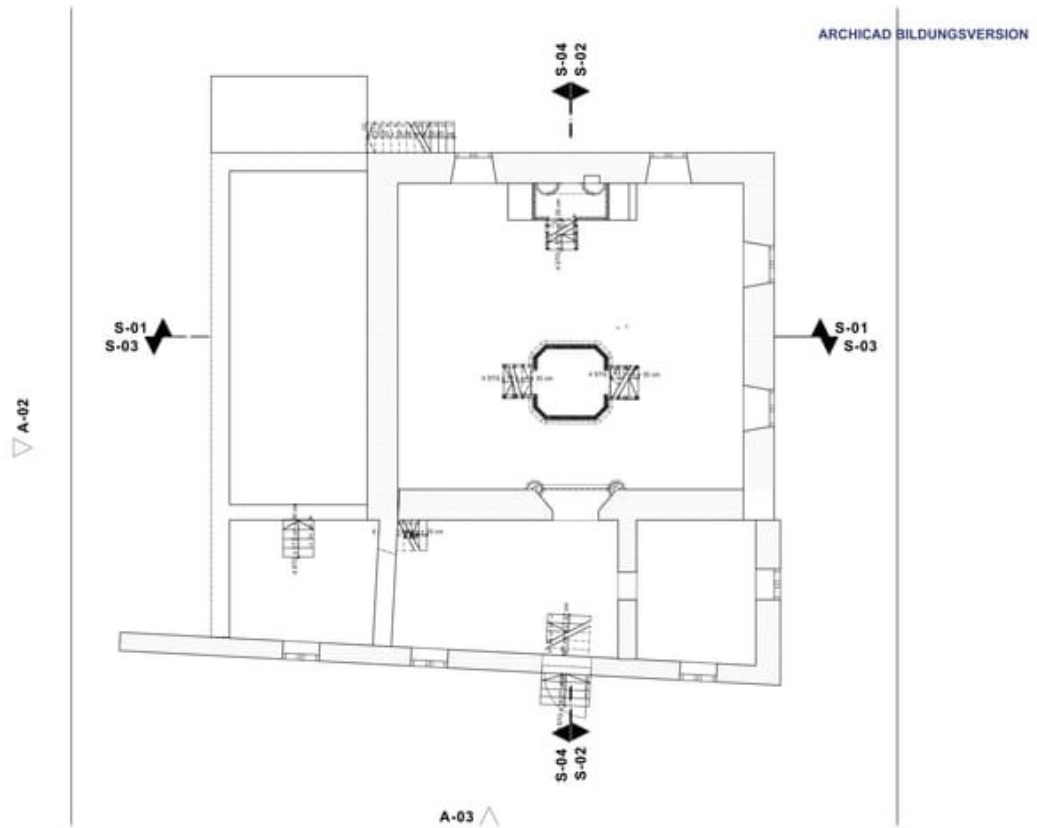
06.01_Grundriss_EG.pdf
